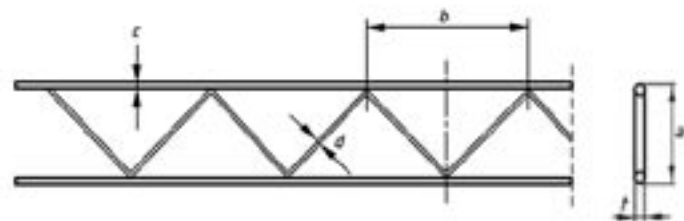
MURFOR® – příhradový typ (truss type)
